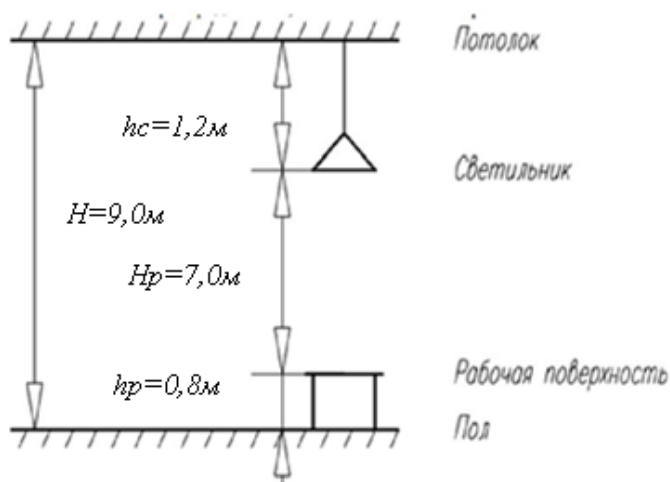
Схематическое размещение светильников по высоте помещения столярного цеха
